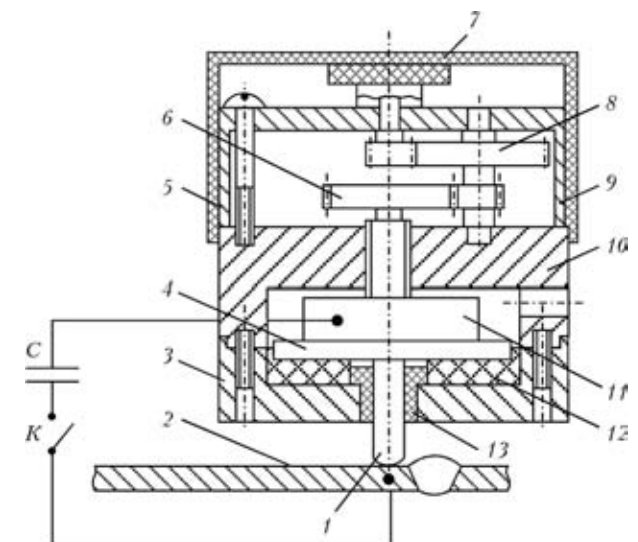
Конструктивная схема рабочего инструмента для ЭДО: 1–13 — см. в тексте; С — батарея конденсаторов; К — коммутатор
